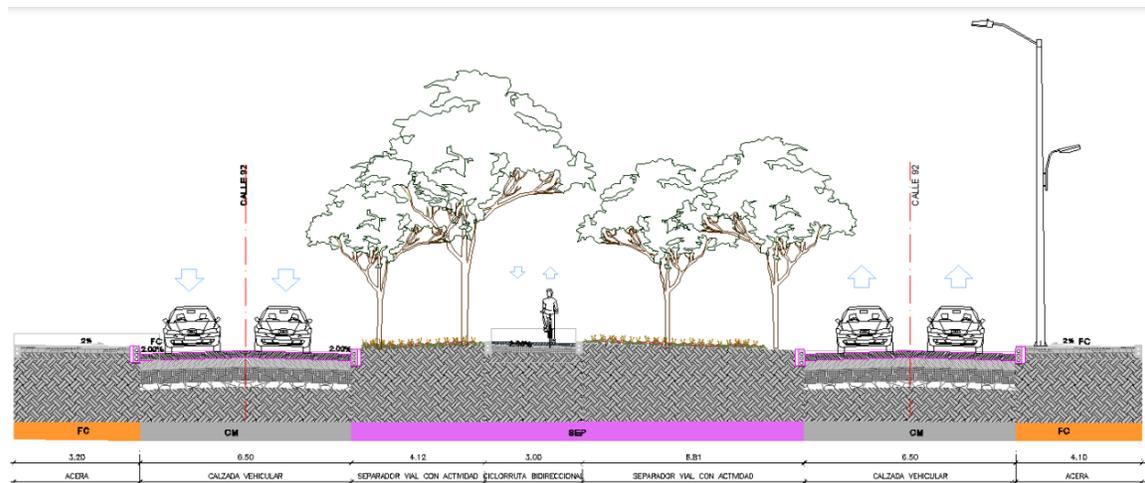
Sección tipo propuesta calle 92 entre Cra 7ª y NQS
